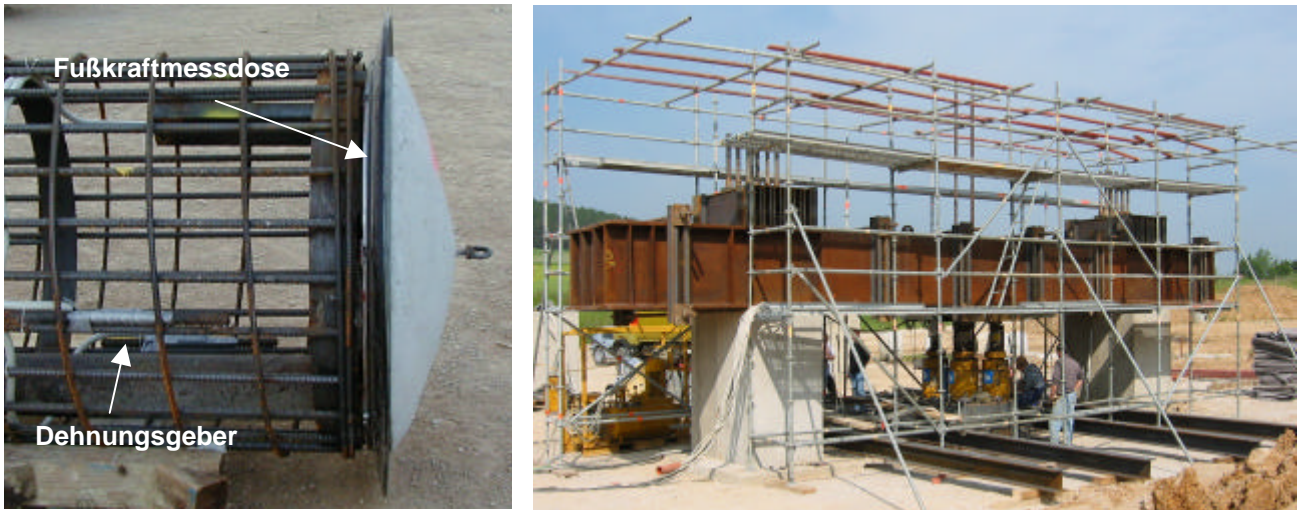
a) Am Bewehrungskorb befestigte Fußkraftmessdose und Dehnungsgeber
